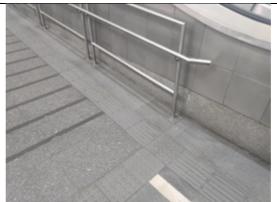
Possui rampa, com inclinação e dimensões adequadas, corrimão e sinalização tátil direcional e alerta.
